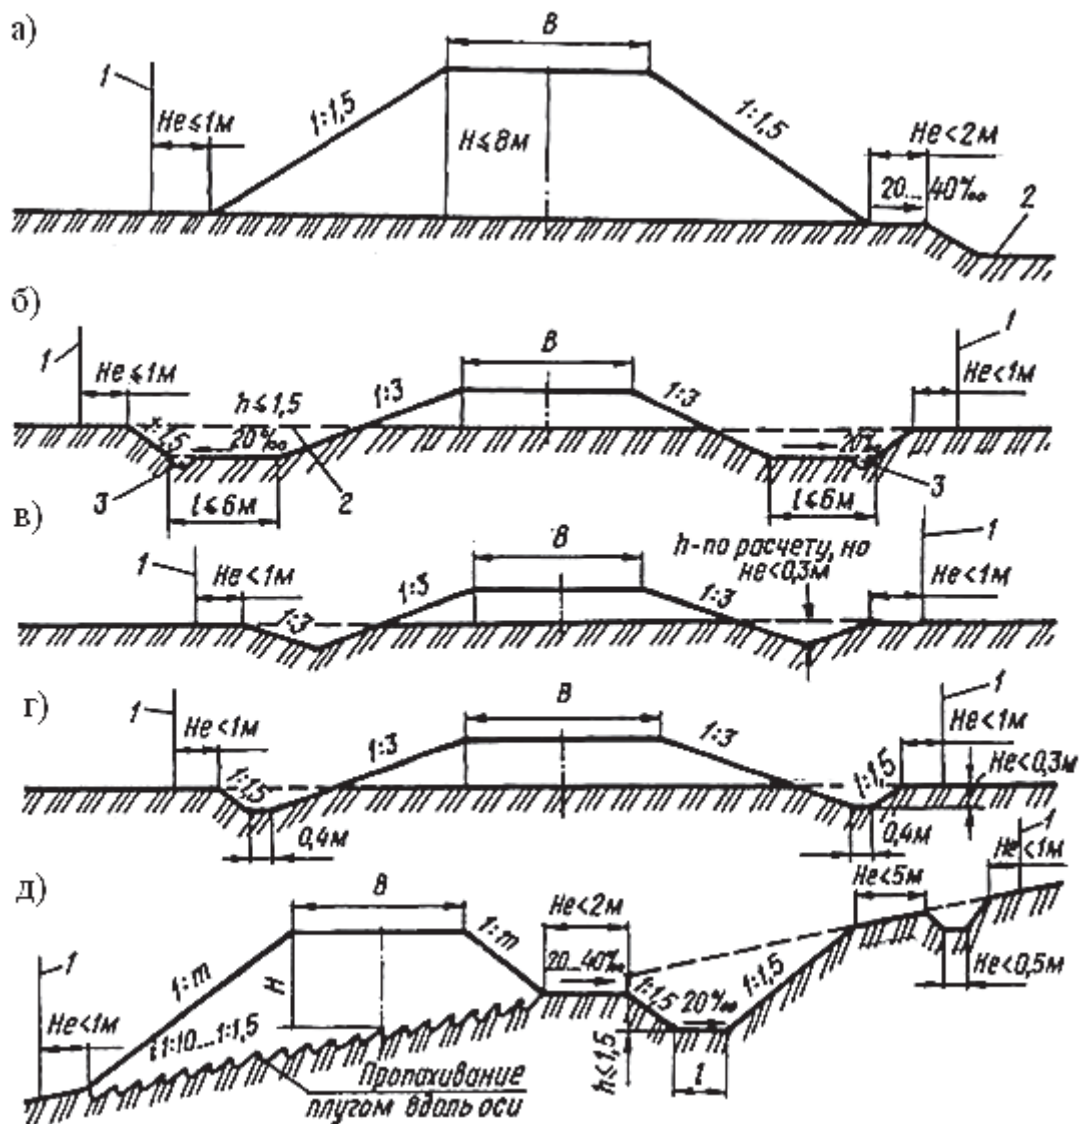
Поперечные профили земляного полотна в насыпях: а – насыпь с откосами 1:1,5; б – то же, 1:3; в – насыпь с треугольными кюветами; г – то же, с трапецидальными кюветами; д – насыпь на косогоре при его уклоне от 1:10 до 1:5; 1 – граница полосы отвода; 2 – резерв, 3 – канава; B – ширина земляного полотна
